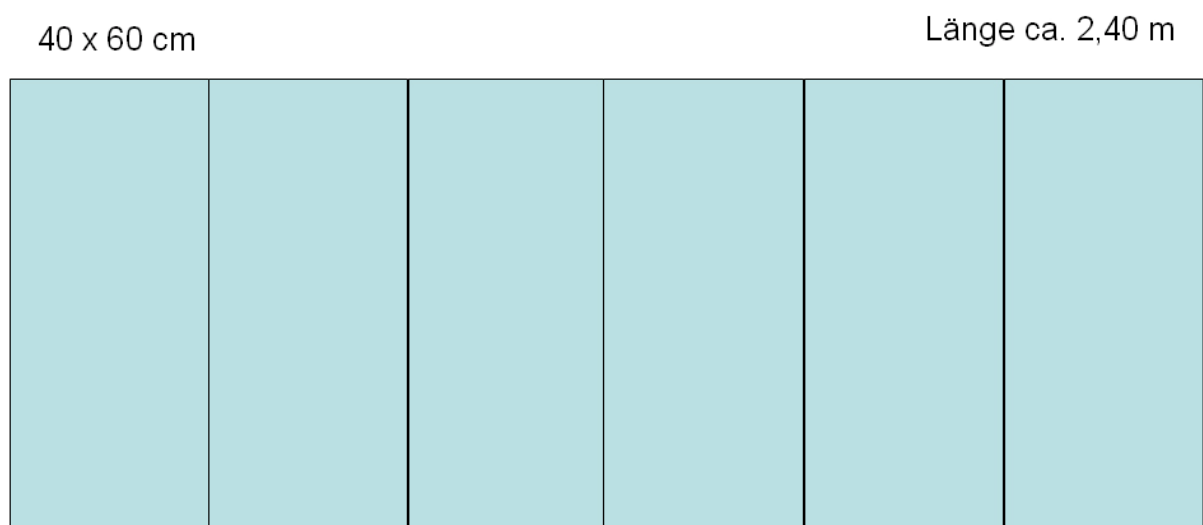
1 Anordnung der Betonplatten auf dem Bockgerüst
